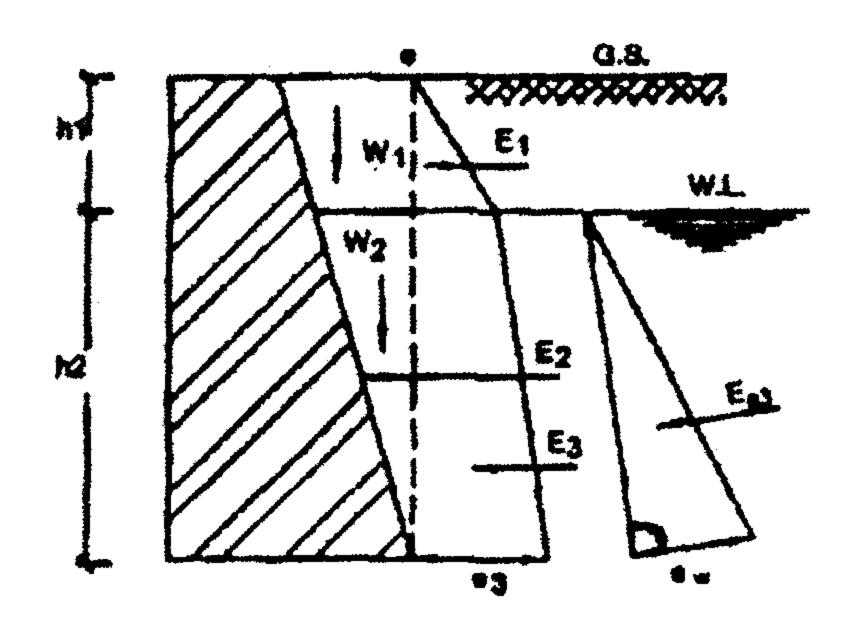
توزيع الضغوط ومثلث القوى
